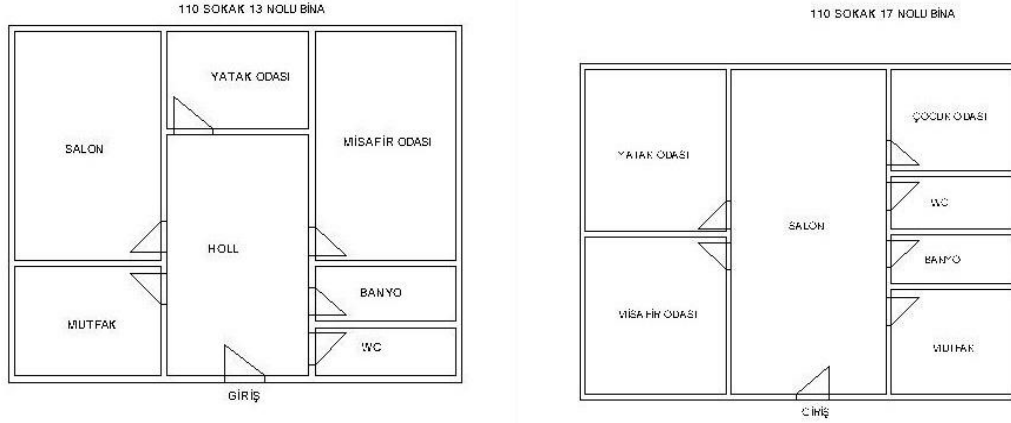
İç – Dış Sofalı Plan Tipi ve Köşeli Sofa Plan Tipi
